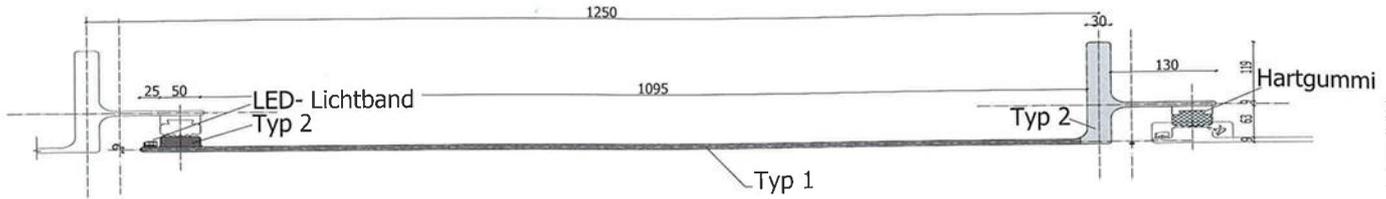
Horizontalschnitt – Abmessungen der größten Lamelle
